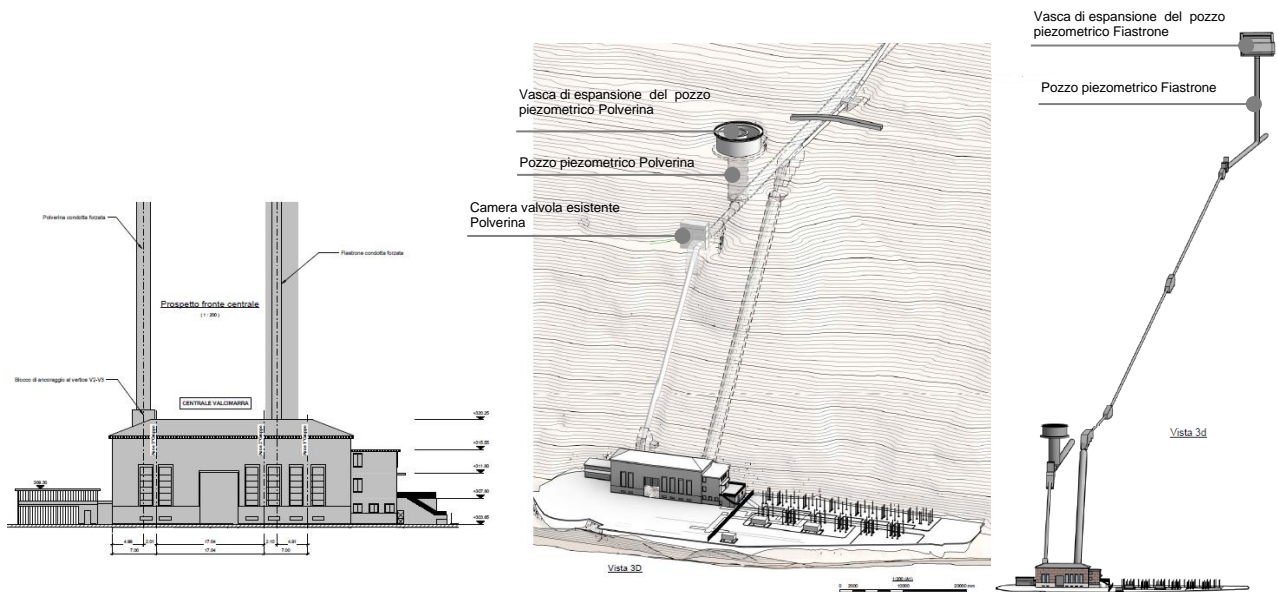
Stato di fatto - Prospetto versante e Centrale. A destra modello 3d della centrale comprendente anche il Pozzo piezometrico Fiastrone con camera di espansione
